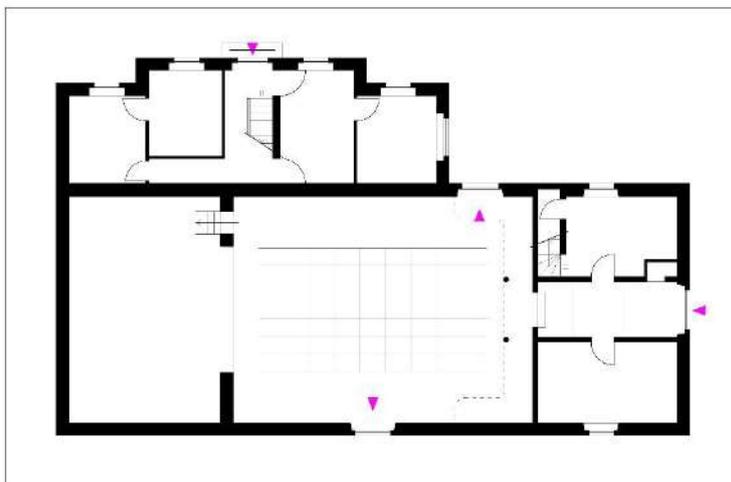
Ipotesi dell'edificio al 1939. Pianta Piano Terra
